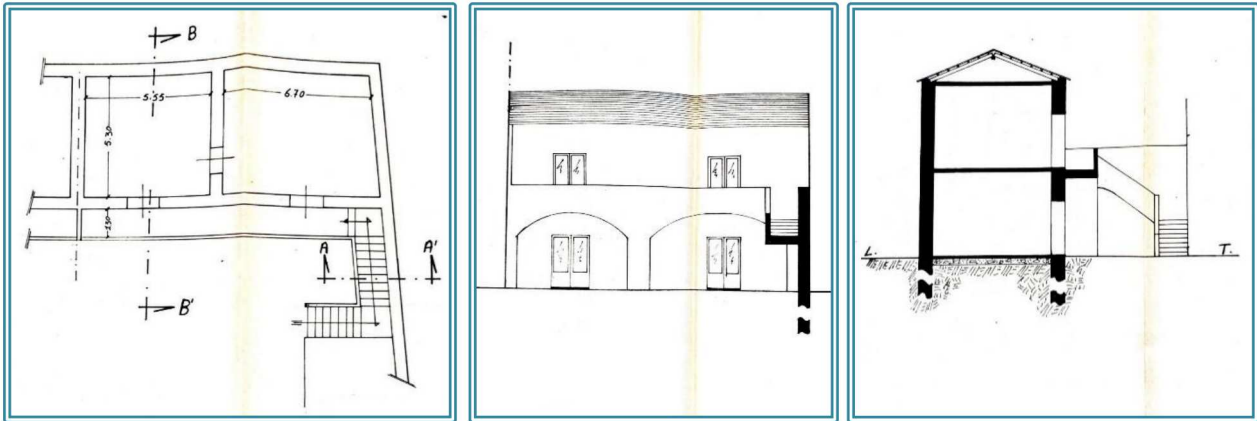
Pianta piano primo, Prospetto e Sezione (ante operam) – estratto dal fascicolo n. 5951 del 17.03.1988
